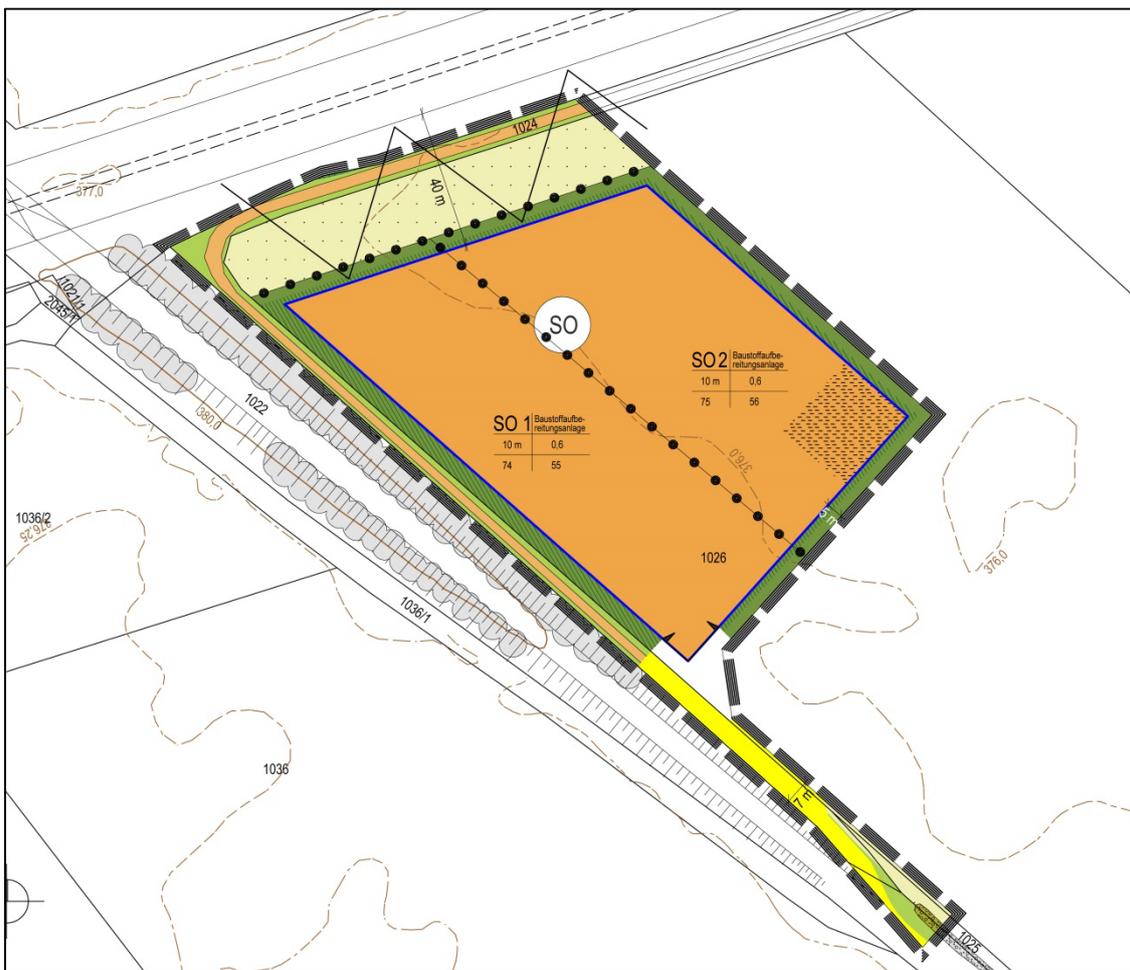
Planzeichnung zum Bebauungsplan "Sondergebiet Baustoffaufbereitungsanlage Unterahrain" des Marktes Essenbach /75/
